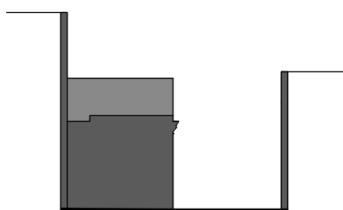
Silueta Urbana Fachada Principal Casa Condal de Pérez Gálvez. Elaboración Propia.
